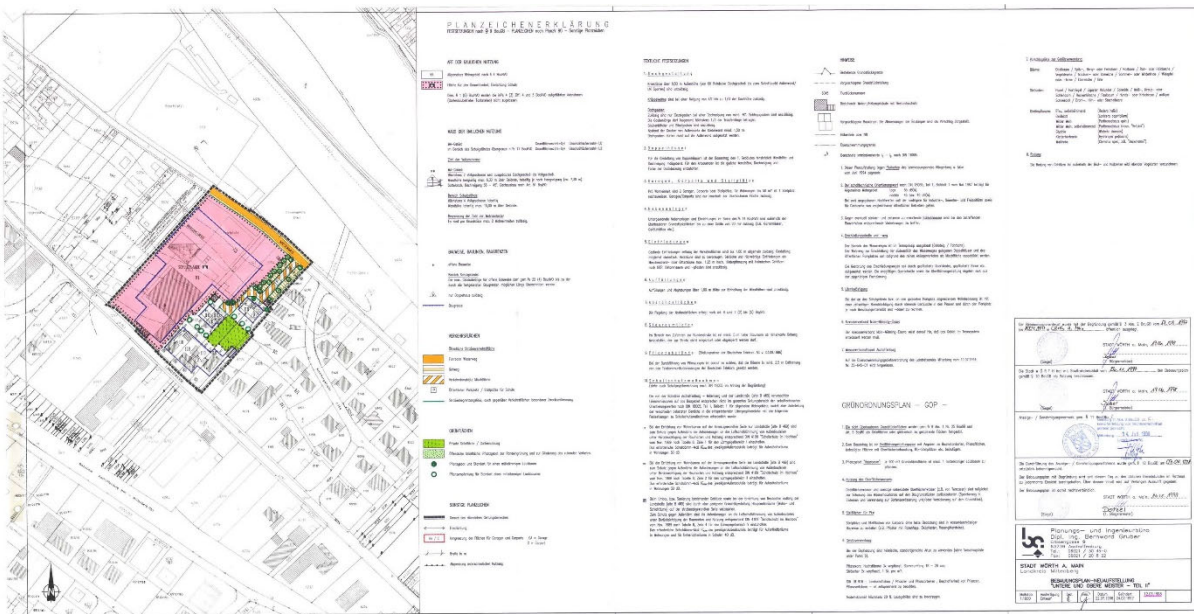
© Daten: rechtskräftiger Bebauungsplan, Stadt Wörth
